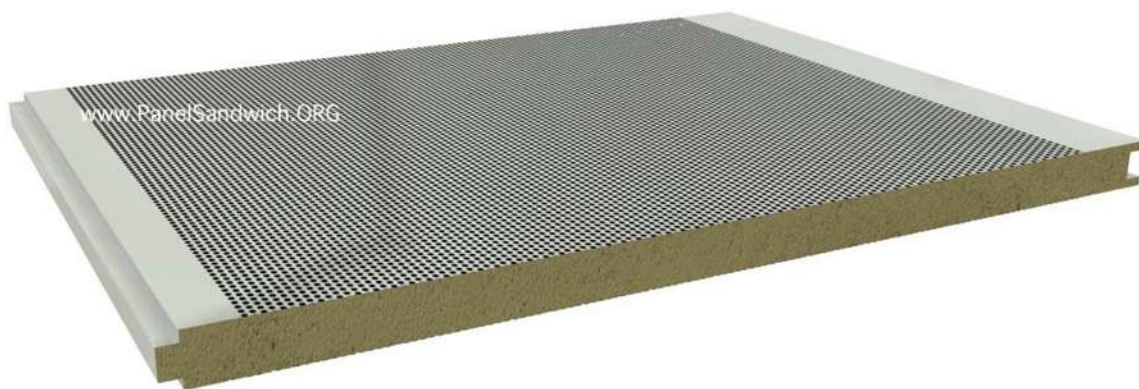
Panel sándwich Lana Roca Fachada Acústico
